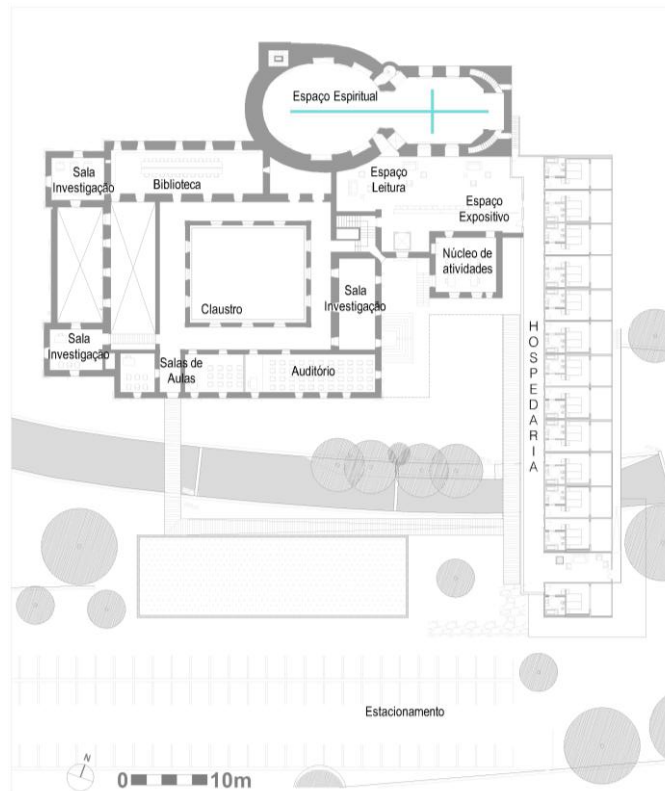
Planta da Proposta, Piso 2. (Ver Anexo IV)
